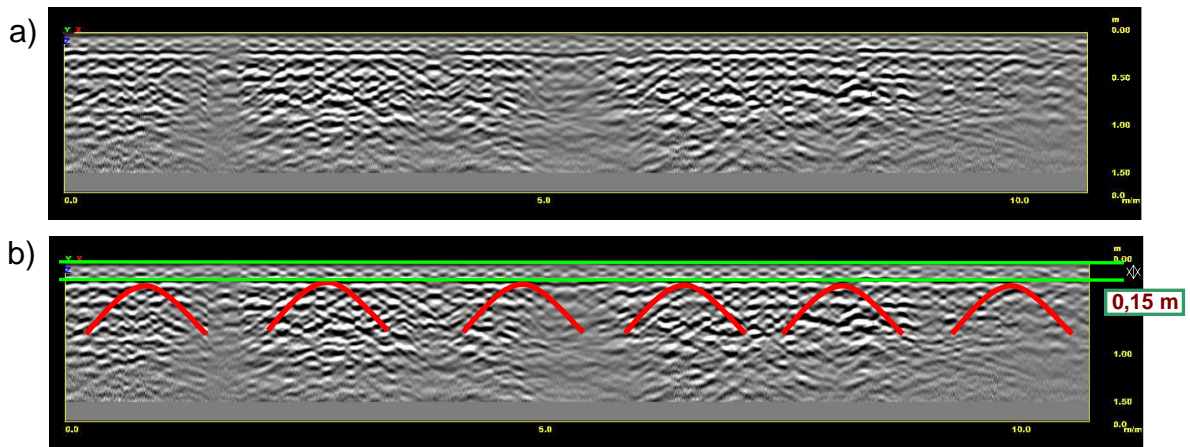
a) Perfil de prospección A, b) Ubicación sobre el perfil de losa de calzada y vigas pretensadas longitudinales
